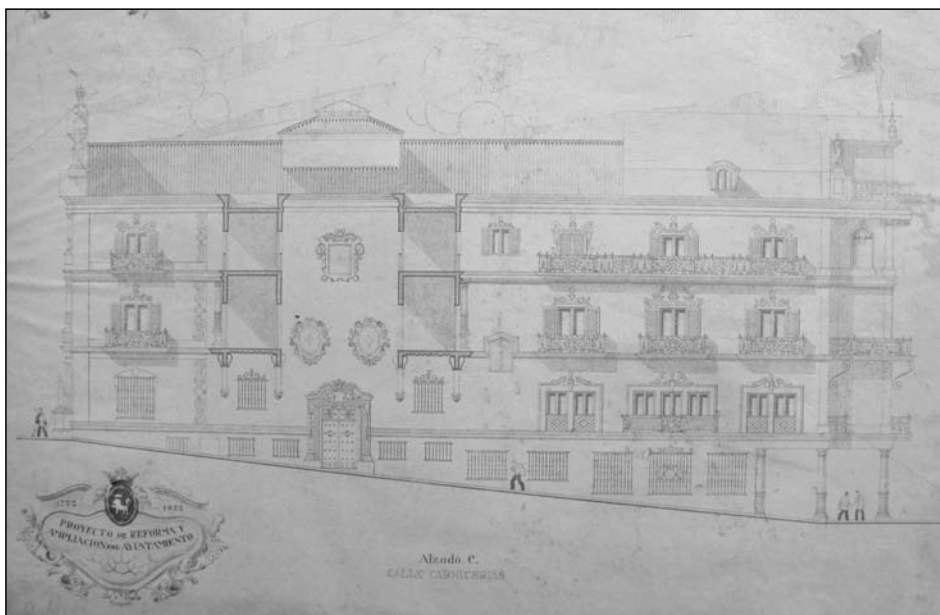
Proyecto de reforma y ampliación del Ayuntamiento. Eugenio Arraiza. Alzado C. Fachada lateral a la calle Carnicerías. AMP
